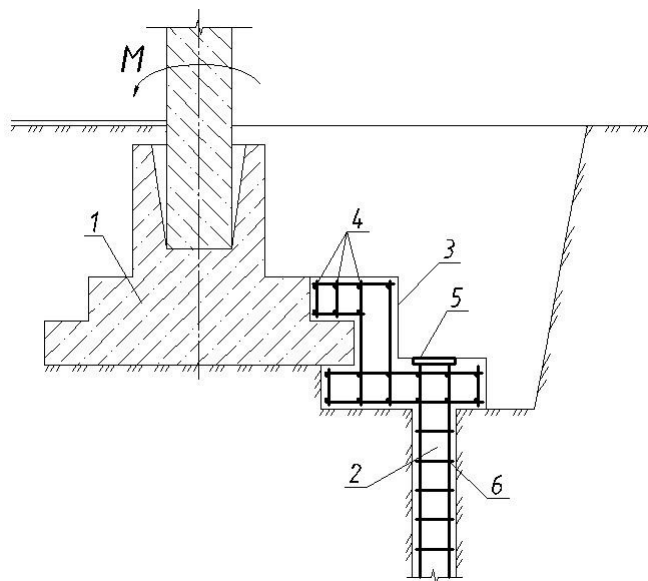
Посилення стовпчастого фундаменту анкерами при дії значного моментного навантаження: 1 – посилюваний фундамент; 2 – анкери з буронабивних армованих палі, що працюють на висмикування; 3 – елемент посилення з моно-
